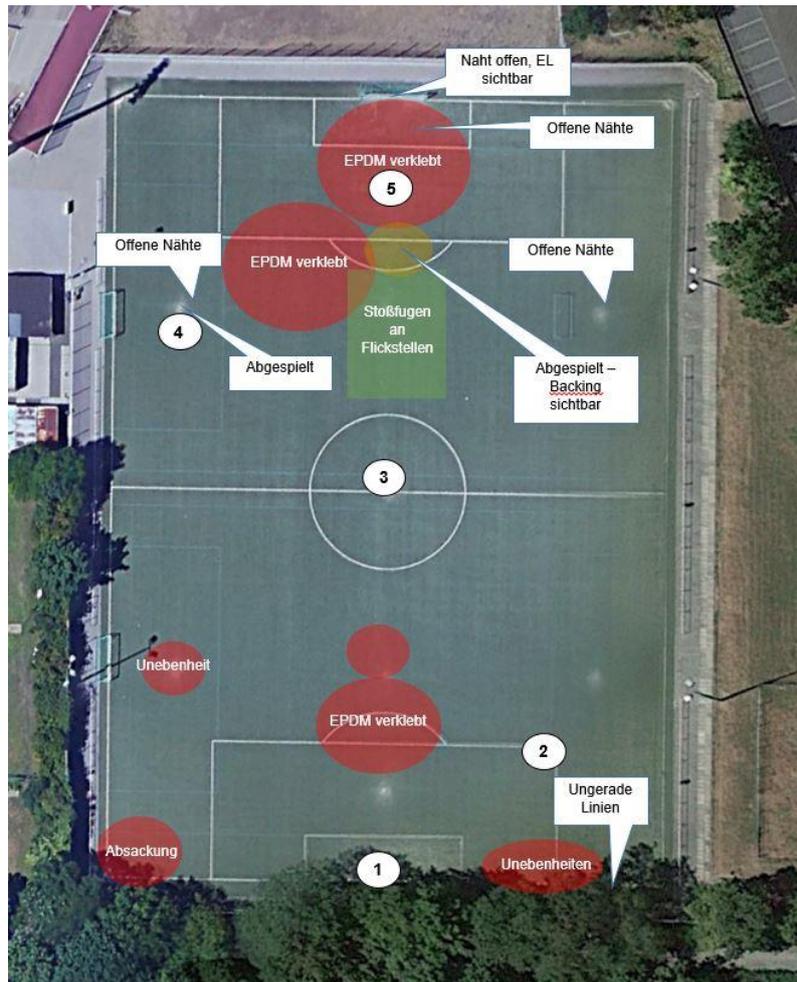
Lageplan mit verorteten Prüfpunkten und Schäden
